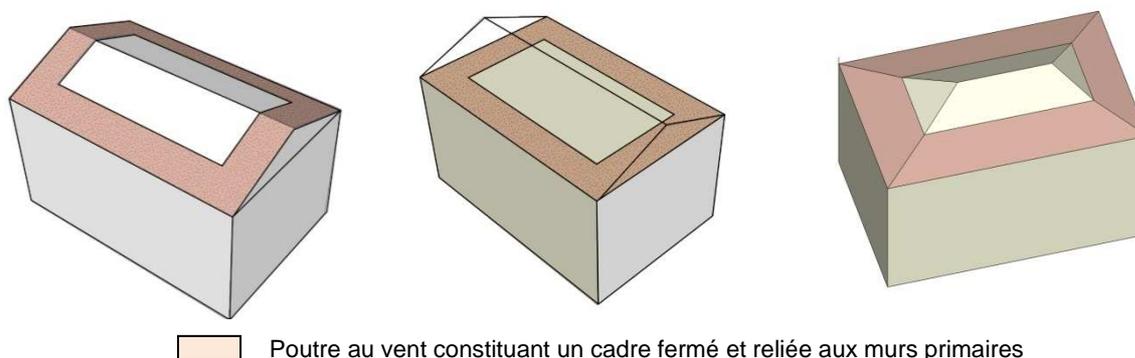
Schémas de principe pour la localisation des éléments créant le diaphragme en toiture : à gauche dans les pans de la toiture, au centre dans un plan horizontal et à droite dans le pan bas de toiture avec brisure de pente
